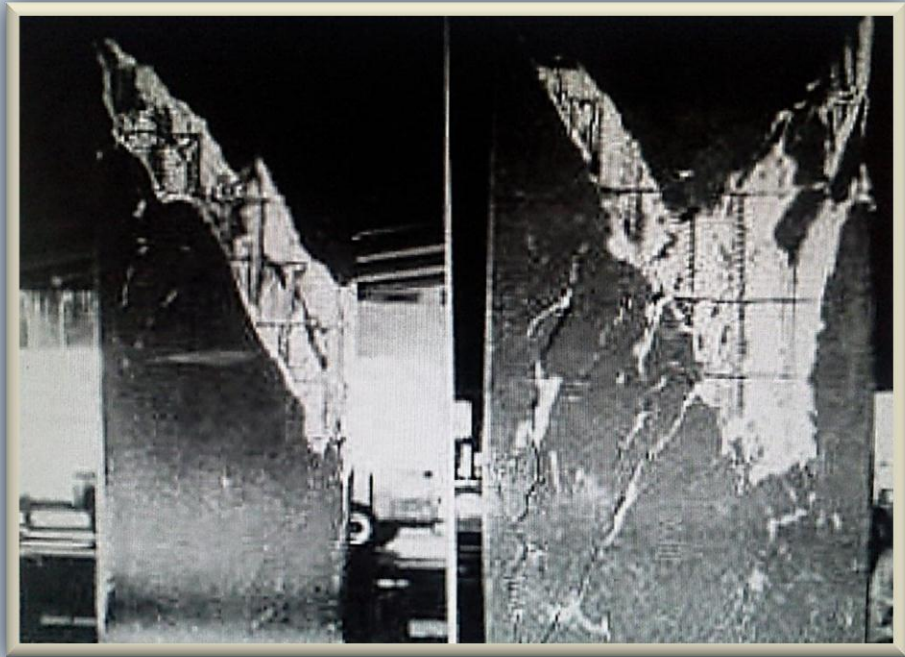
a.1-3) Más ejemplos de fallas típicas por cortante en columnas de concreto reforzado
